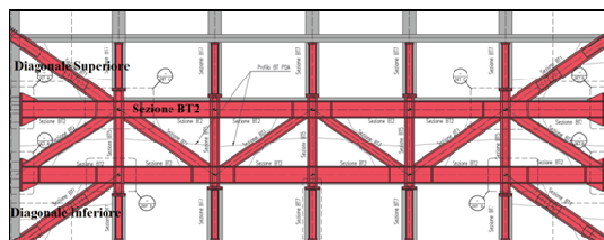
Schema della Belt-Truss in carpenteria metallica
